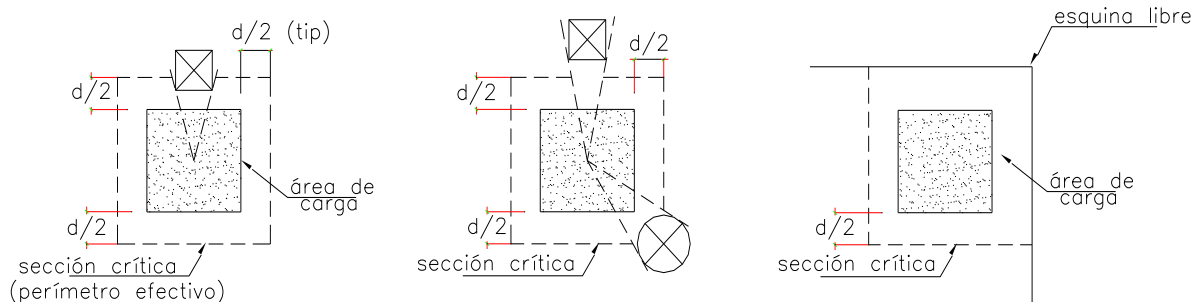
Aberturas y bordes libres en losas (las líneas discontinuas muestran el perímetro efectivo).
